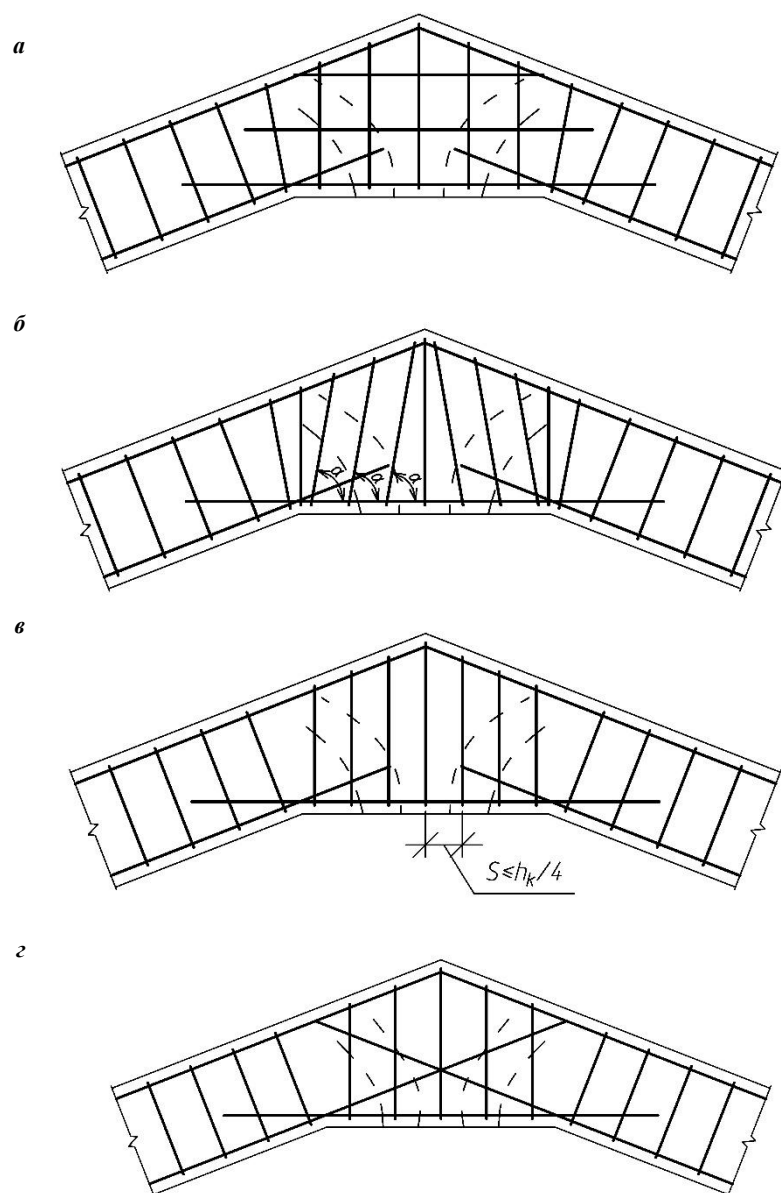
Схема армирования конькового узла монолитных рам [8]
